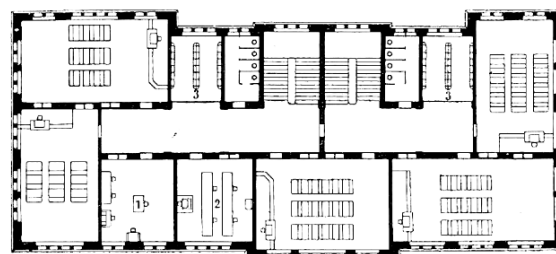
Plan du premier étage. Echelle : 1/500.
